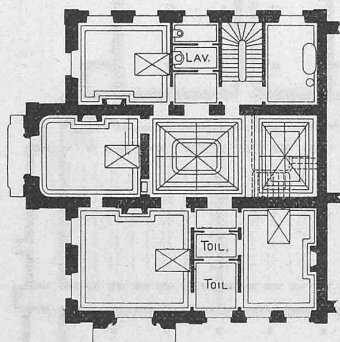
et 12. Pavillons d'habitation. — Plan du rez-de-chaussée et plan du premier étage de l'aile ouest.
